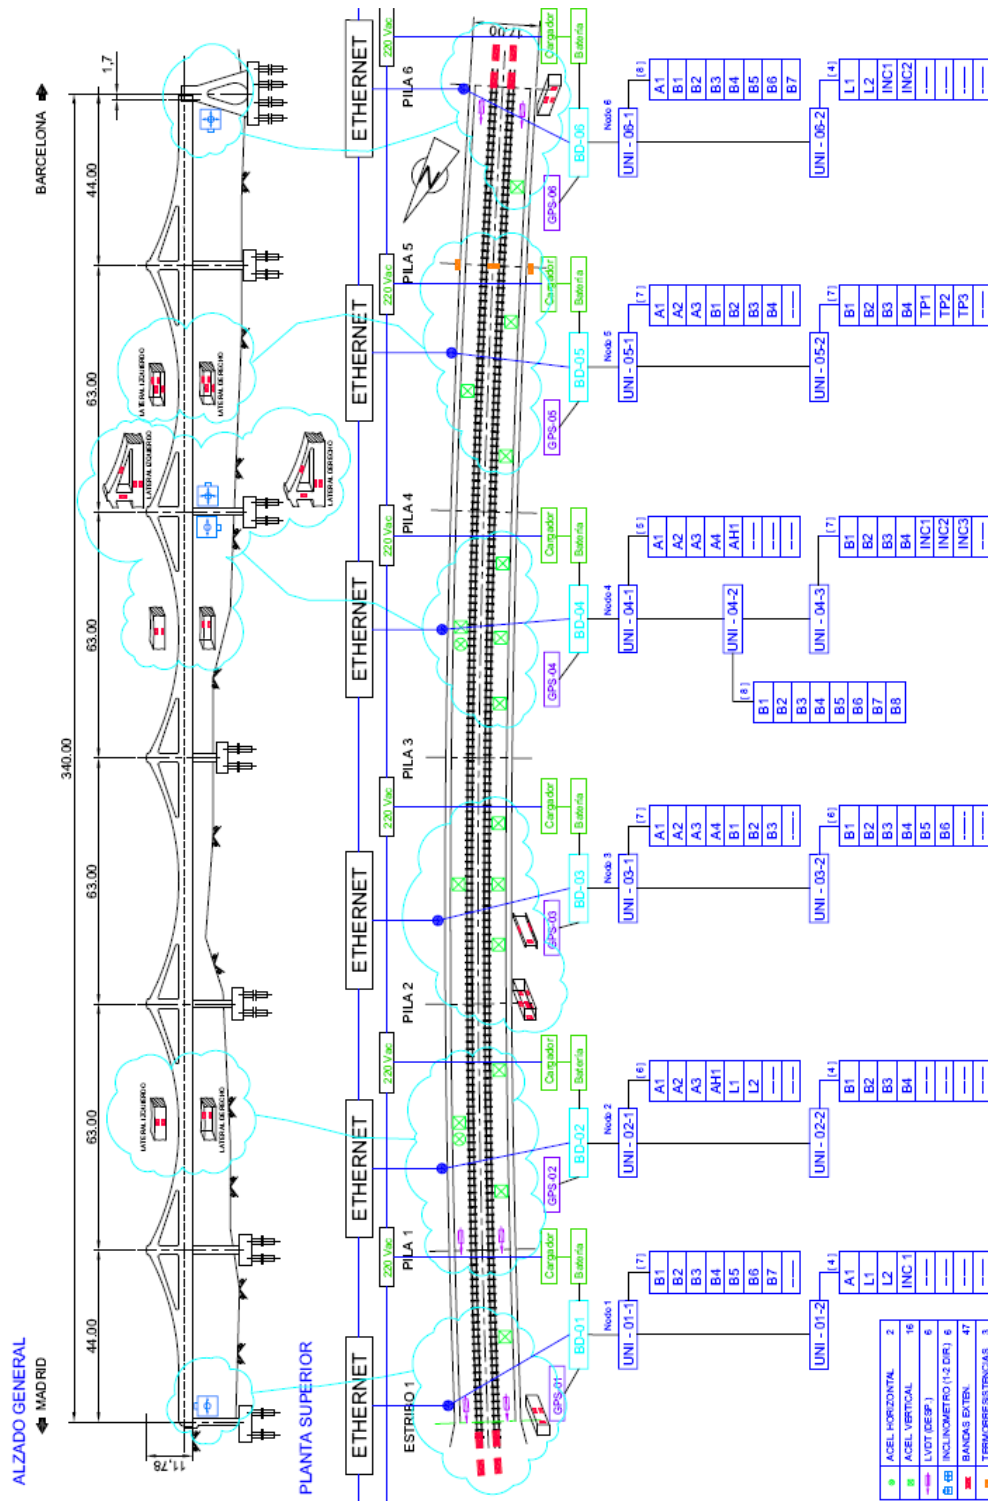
Plano de Instrumentación del viaducto de Sanboi (mixto). Cortesía del CEDEX.
